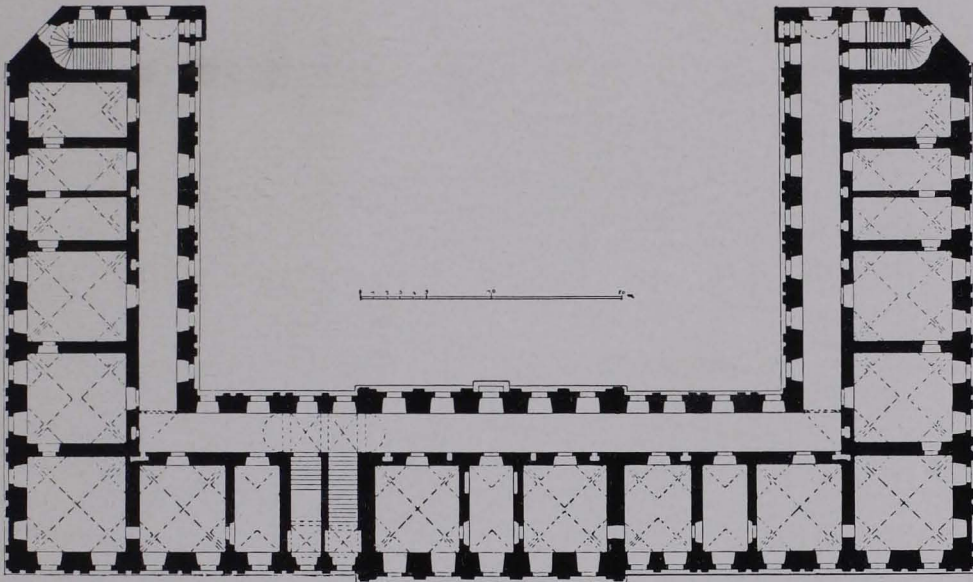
Pläß, Prälatur. Grundriß, Erdgeschoß *Rekonstruktion gemeinsam mit Arch. S. Bauer
